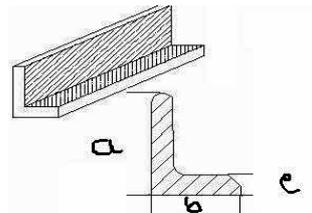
Perfil en L (www.ConstruAprende.com)
